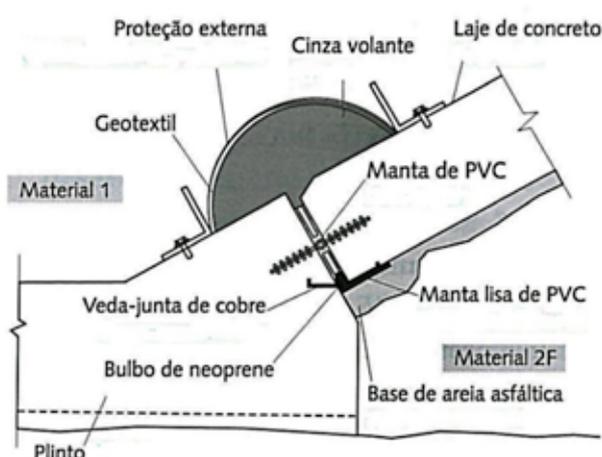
Junta perimetral. Utilização de cinza volante em alternativa ao mastique. Barragem de Aguamilpa, México.
